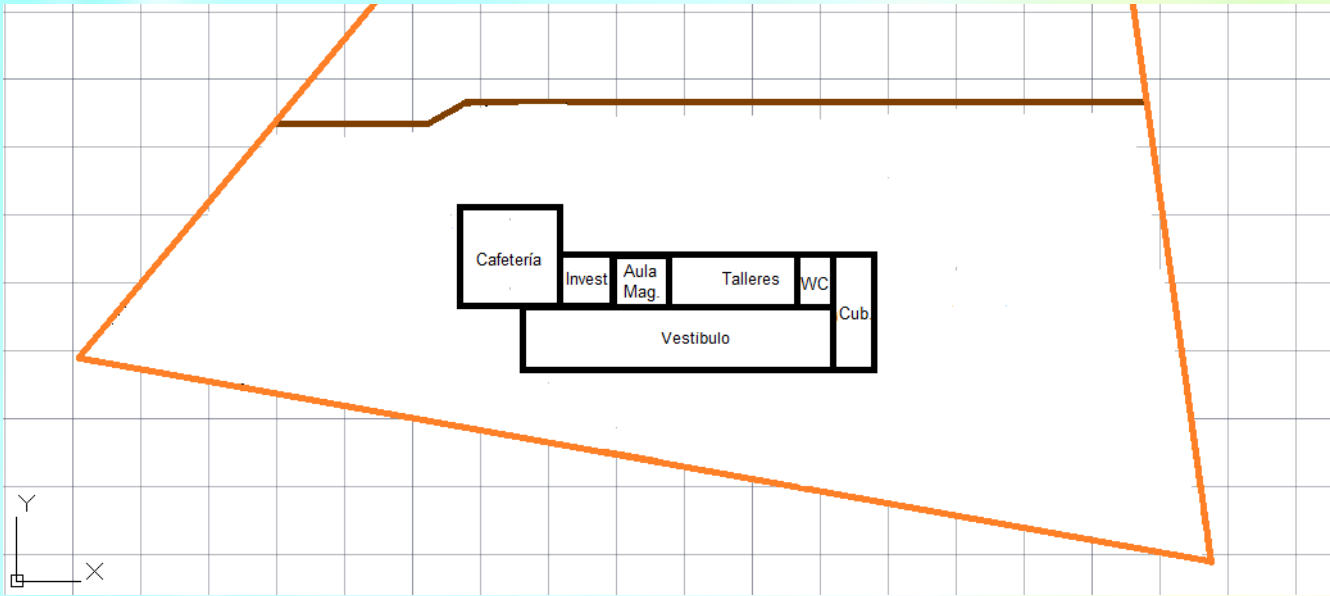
, Zonificación Tercera Planta, Foto EDGM
